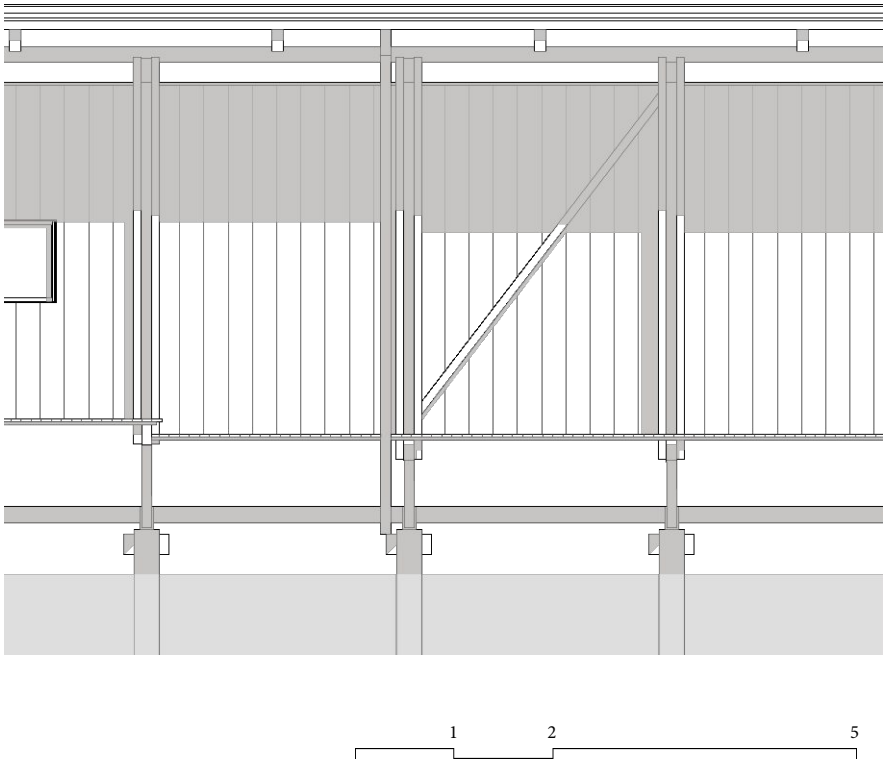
| Fassadenschnitt. Aufbau Bestandssteg.
